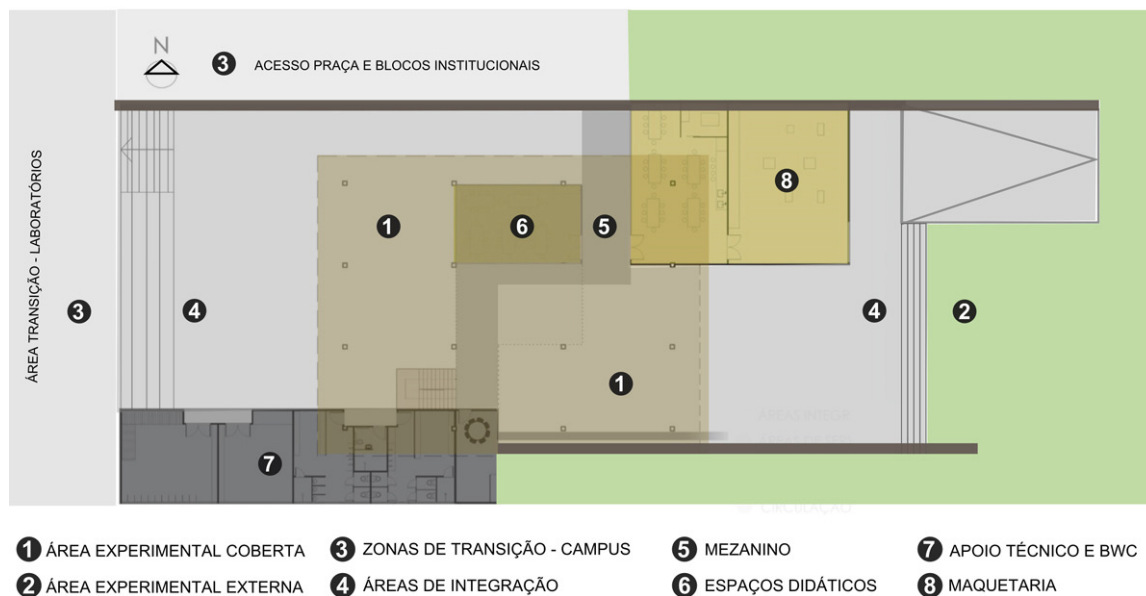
Planta esquemática dos espaços de experimentação. Fonte: Elaborada pelos autores.
